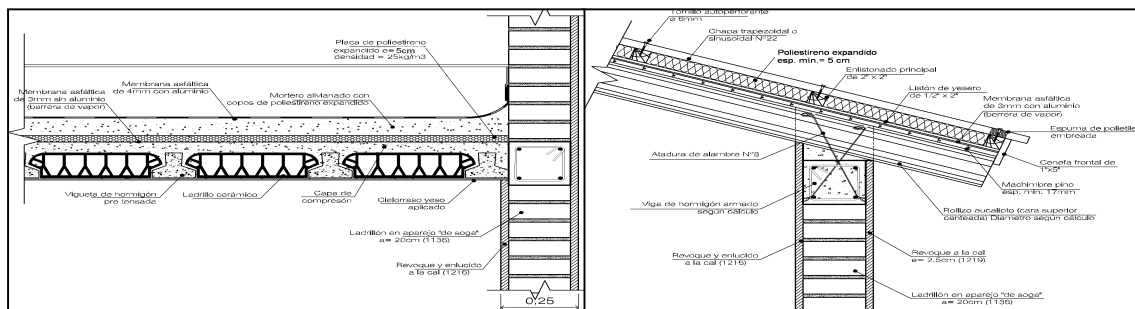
Detalles constructivos de las envolventes de las viviendas. Cubierta plana e inclinada.
